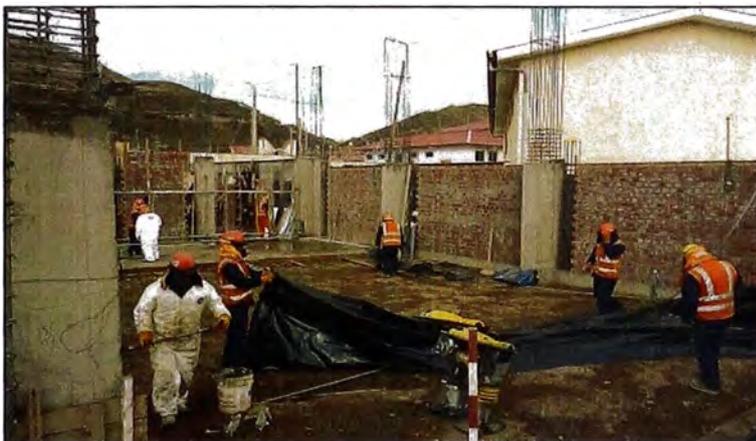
Concreto en columnas de primer nivel, asentado de ladrillo y relleno de zanjas de cimentación
